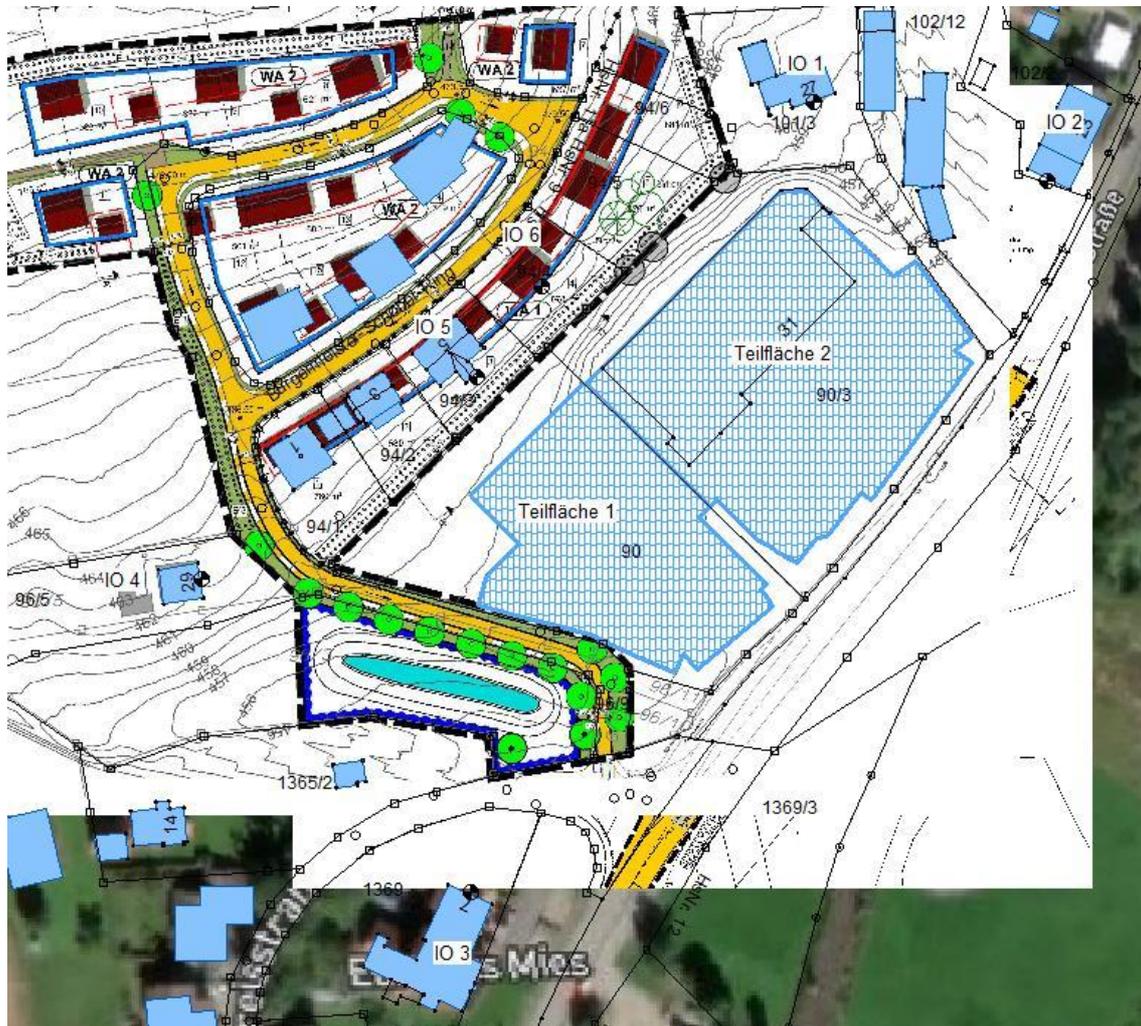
Lageplan mit Kennzeichnung der Immissionsorte IO 1 – IO 6
